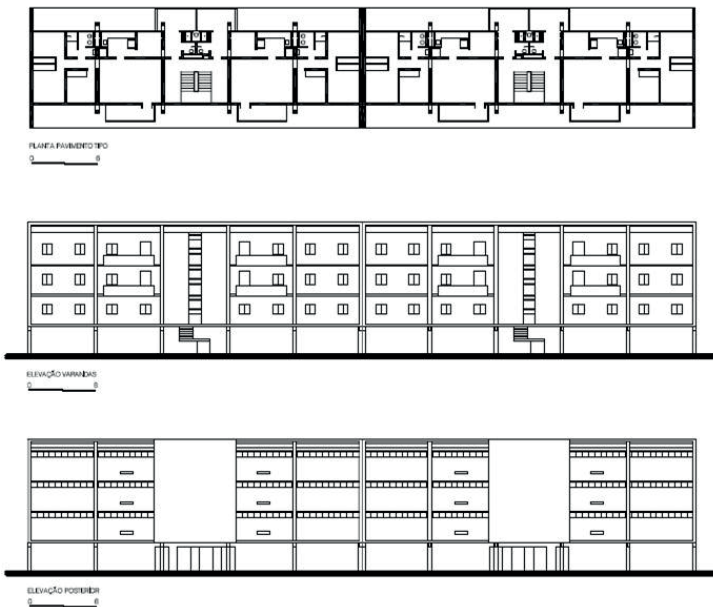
Planta e alevações de bloco RE com dois módulos. Fonte: Acervo Milton Ramos
